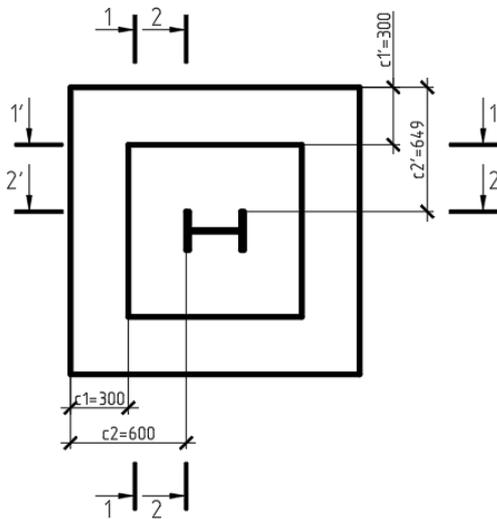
Схема к расчету арматуры плитной части фундамента
